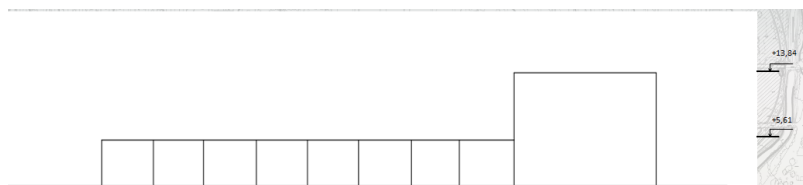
Perfil Calle Comercio fuente: La autora (2022)
